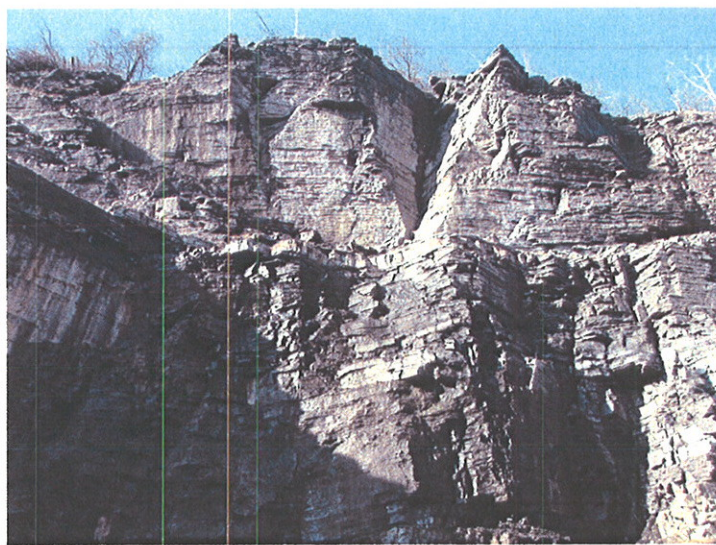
Section 4, vue détaillée d'une partie de la paroi
